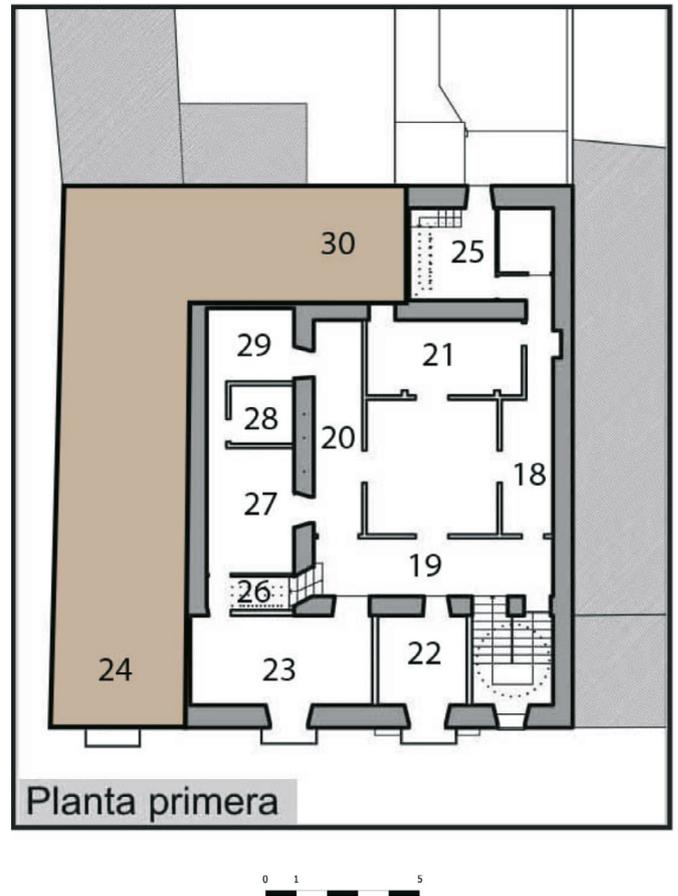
Plano de la planta primera, a partir del levantamiento de D. Alberto J. García Martos.
